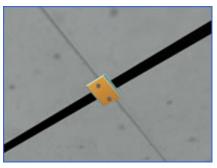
預力混凝土及鋼 MD 合成橋工法
